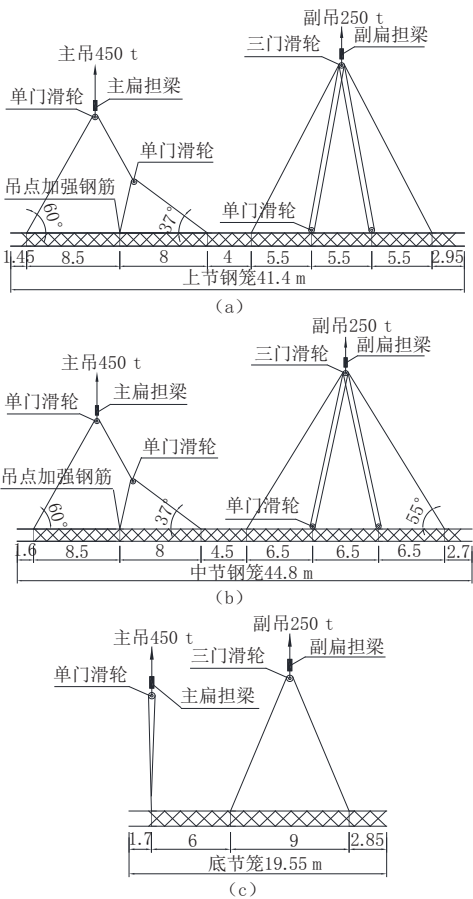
105 m地墙上、中、下三节钢筋笼吊点设置示意图(单位:m)
